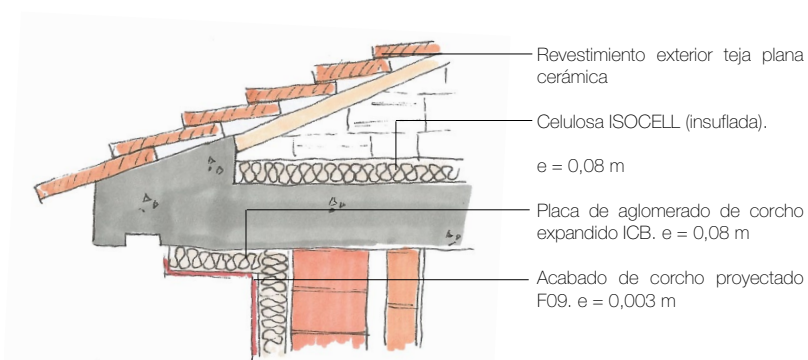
Detalle encuentro de fachada aislada con sistema SATE y cubierta inclinada aislada en el bajo cubierta (autoría propia).
